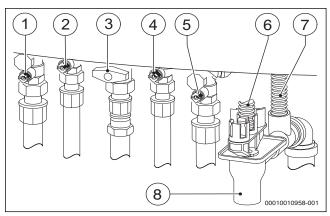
Gas- und wasserseitige Anschlüsse (Zubehör)
